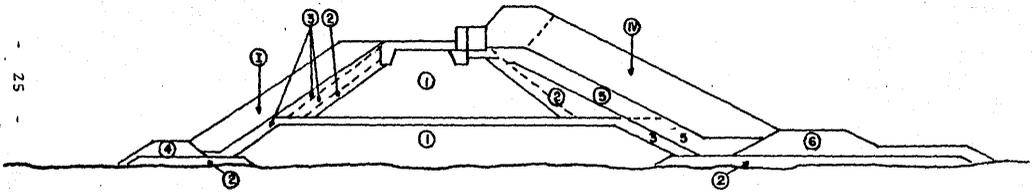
Tipo de roca y bloques de concreto en sección VII
